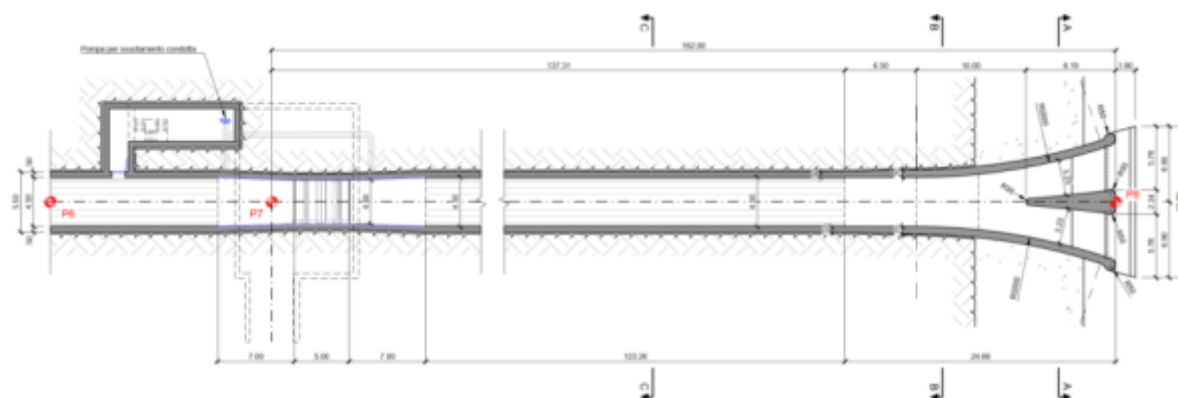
Nuova galleria forzata di scarico/aspirazione sulla derivazione Piaganini – zona della nuova presa - pianta
